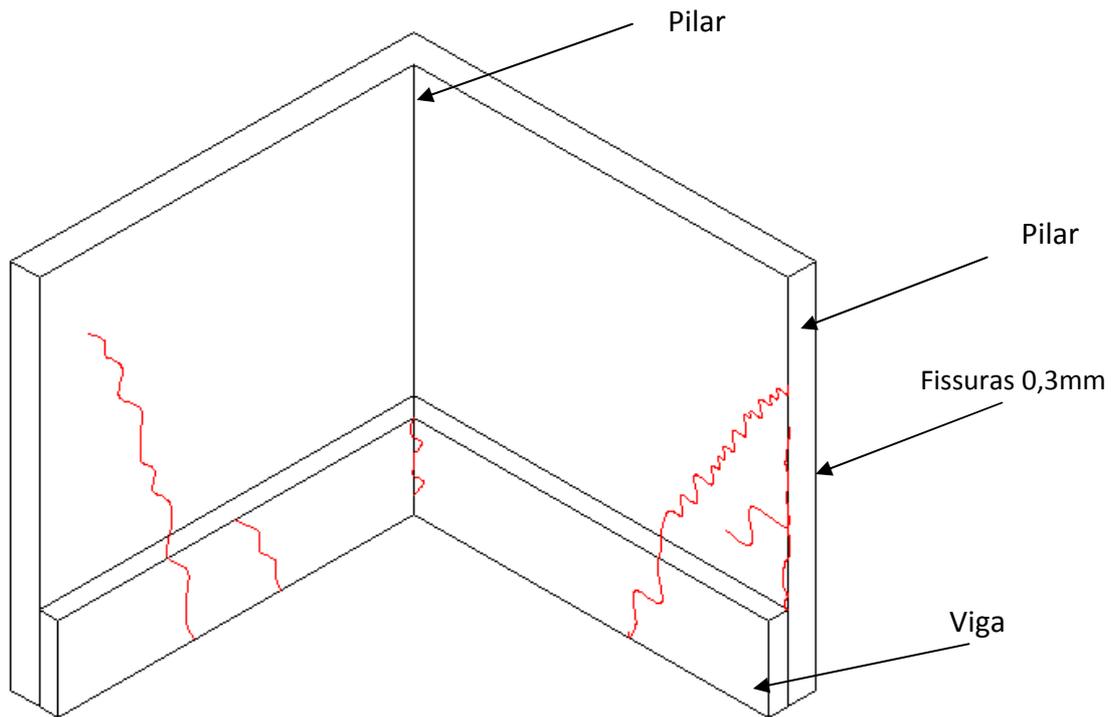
Esquema com as fissuras na parede de periferia do 10º andar (auditório). Fachada posterior.
